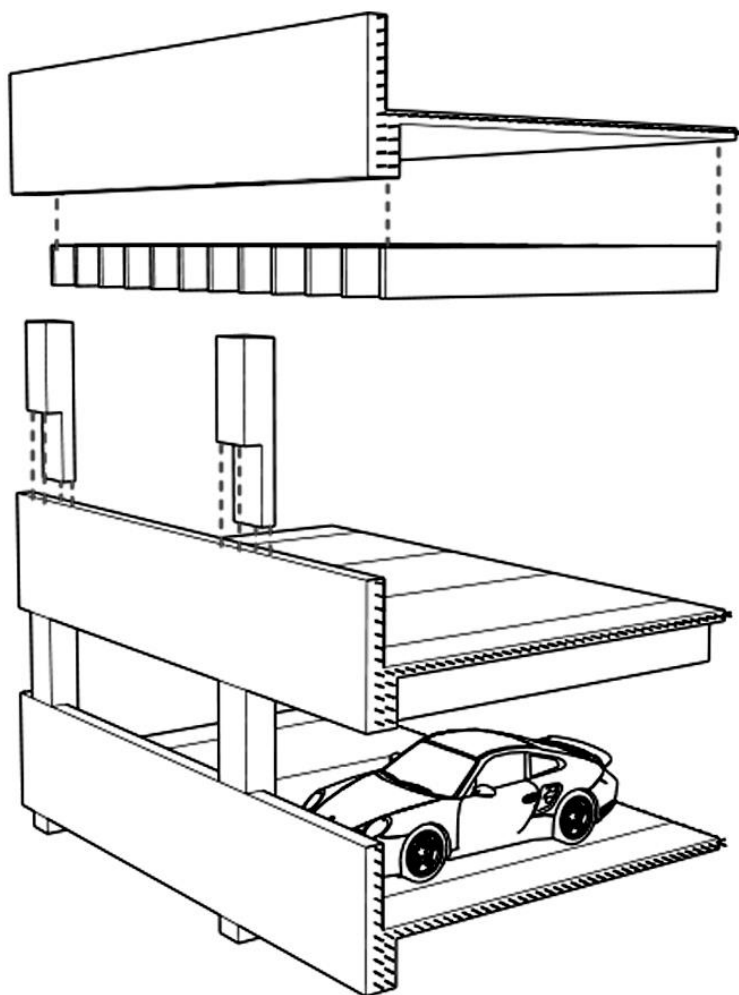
Схематичное изображение опирания ребристой плиты перекрытия на колонны.
